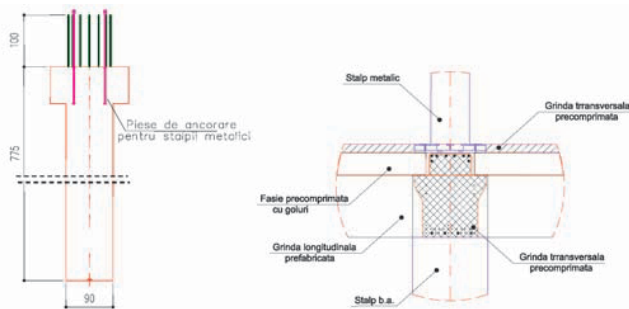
Elementele structurii din beton: a) stâlp prefabricat; b) grinzi din beton și fâșii cu goluri
